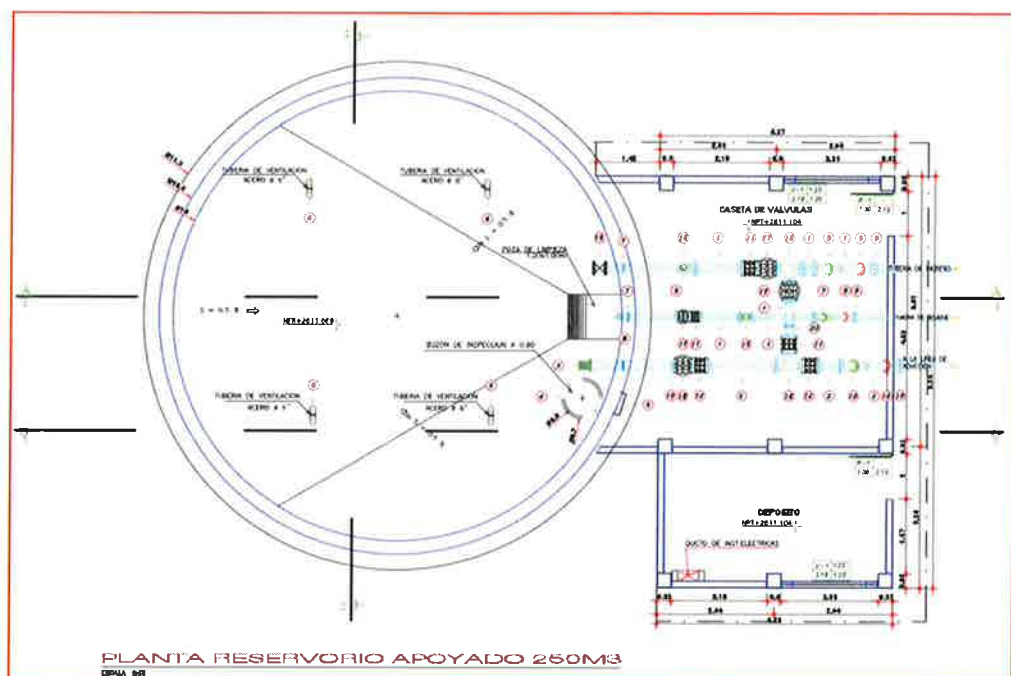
Plano en Planta: Reservoirio Apoyado de 265m3
